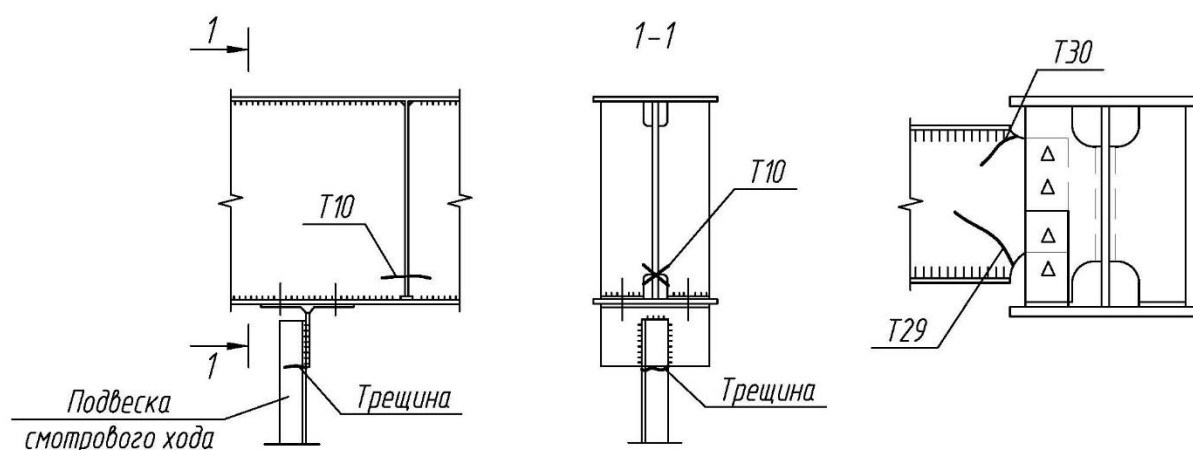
Типы усталостных трещин в пролетных строениях со сквозными фермами с ездой поверху
